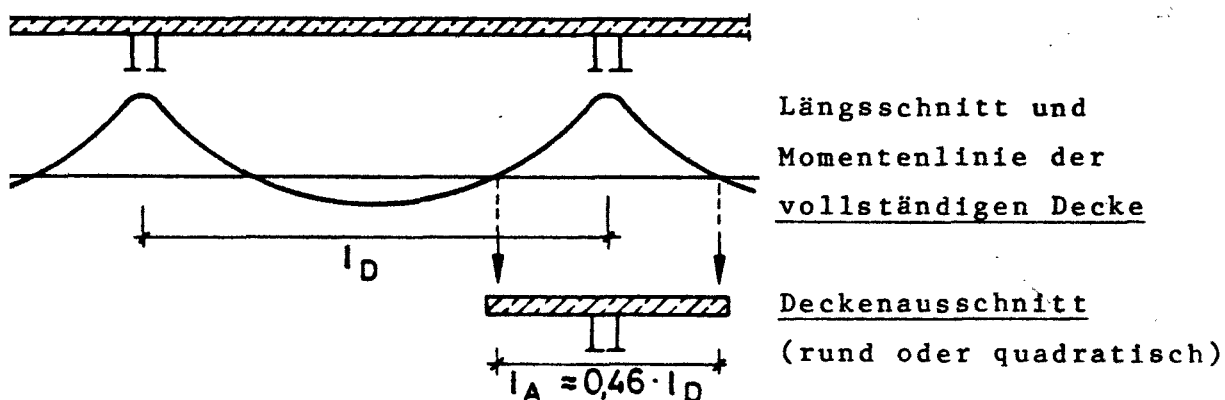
Bildung eines Deckenausschnittes aus einer Flach- oder Pilzdecke
